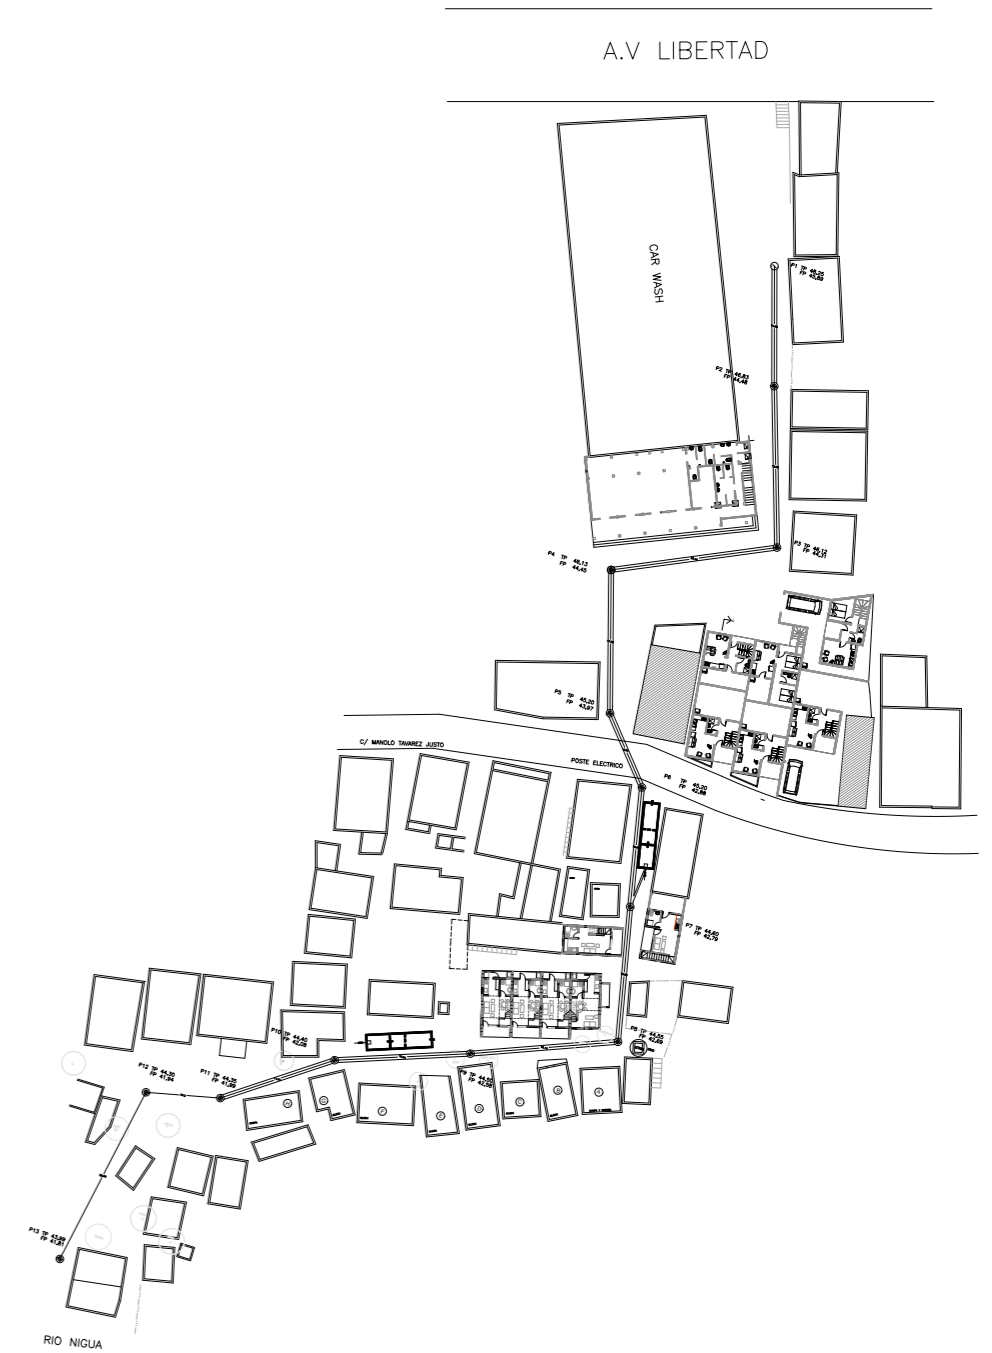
Solución definitiva del trazado de las infraestructuras de la cañada Piscina, con el centro comunal, la solución dada a las UBIs y el sistema de depuración primario.
